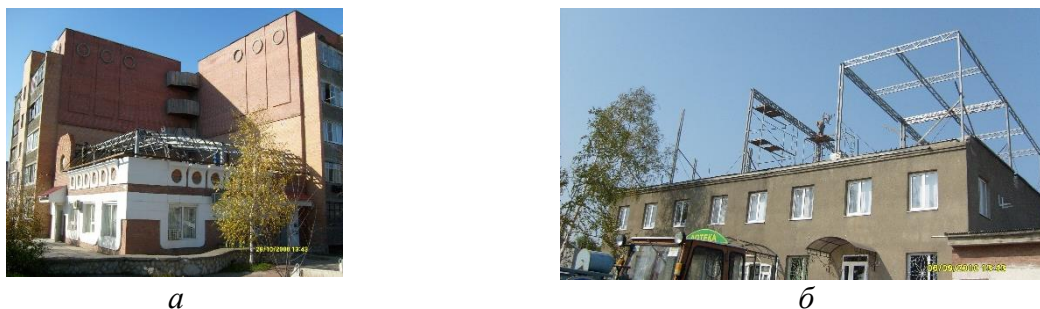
Снимки реконструкции 1-этажного здания с гибким верхним этажом из 4 модулей 5×5 м (а) и 2-этажного здания с гибким верхним этажом из 8 модулей 6×6 м (б)
